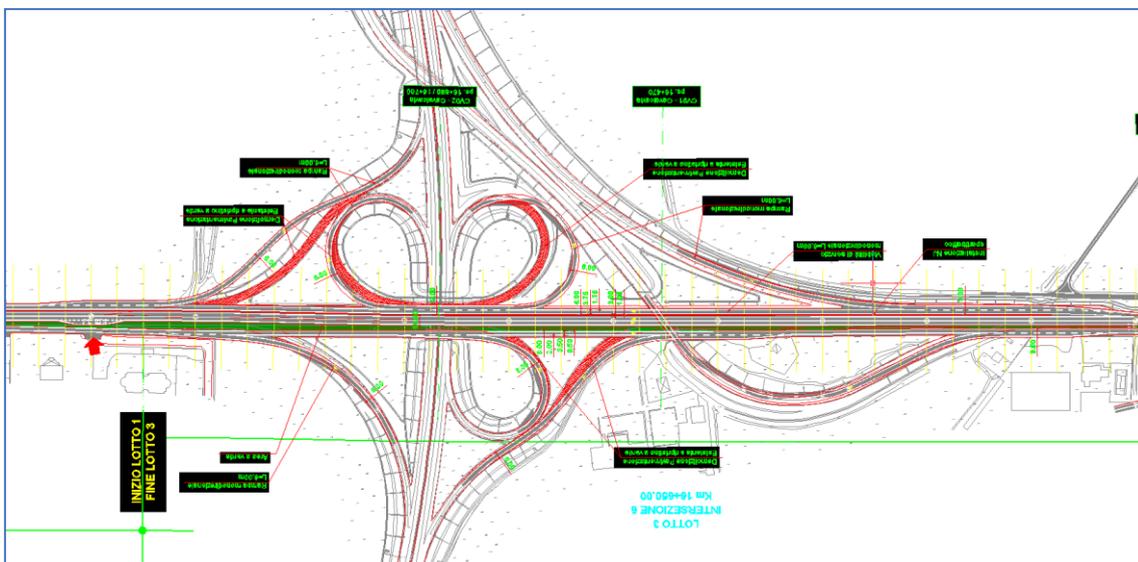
Intersezione 6 - Km 16+650 - Progetto
